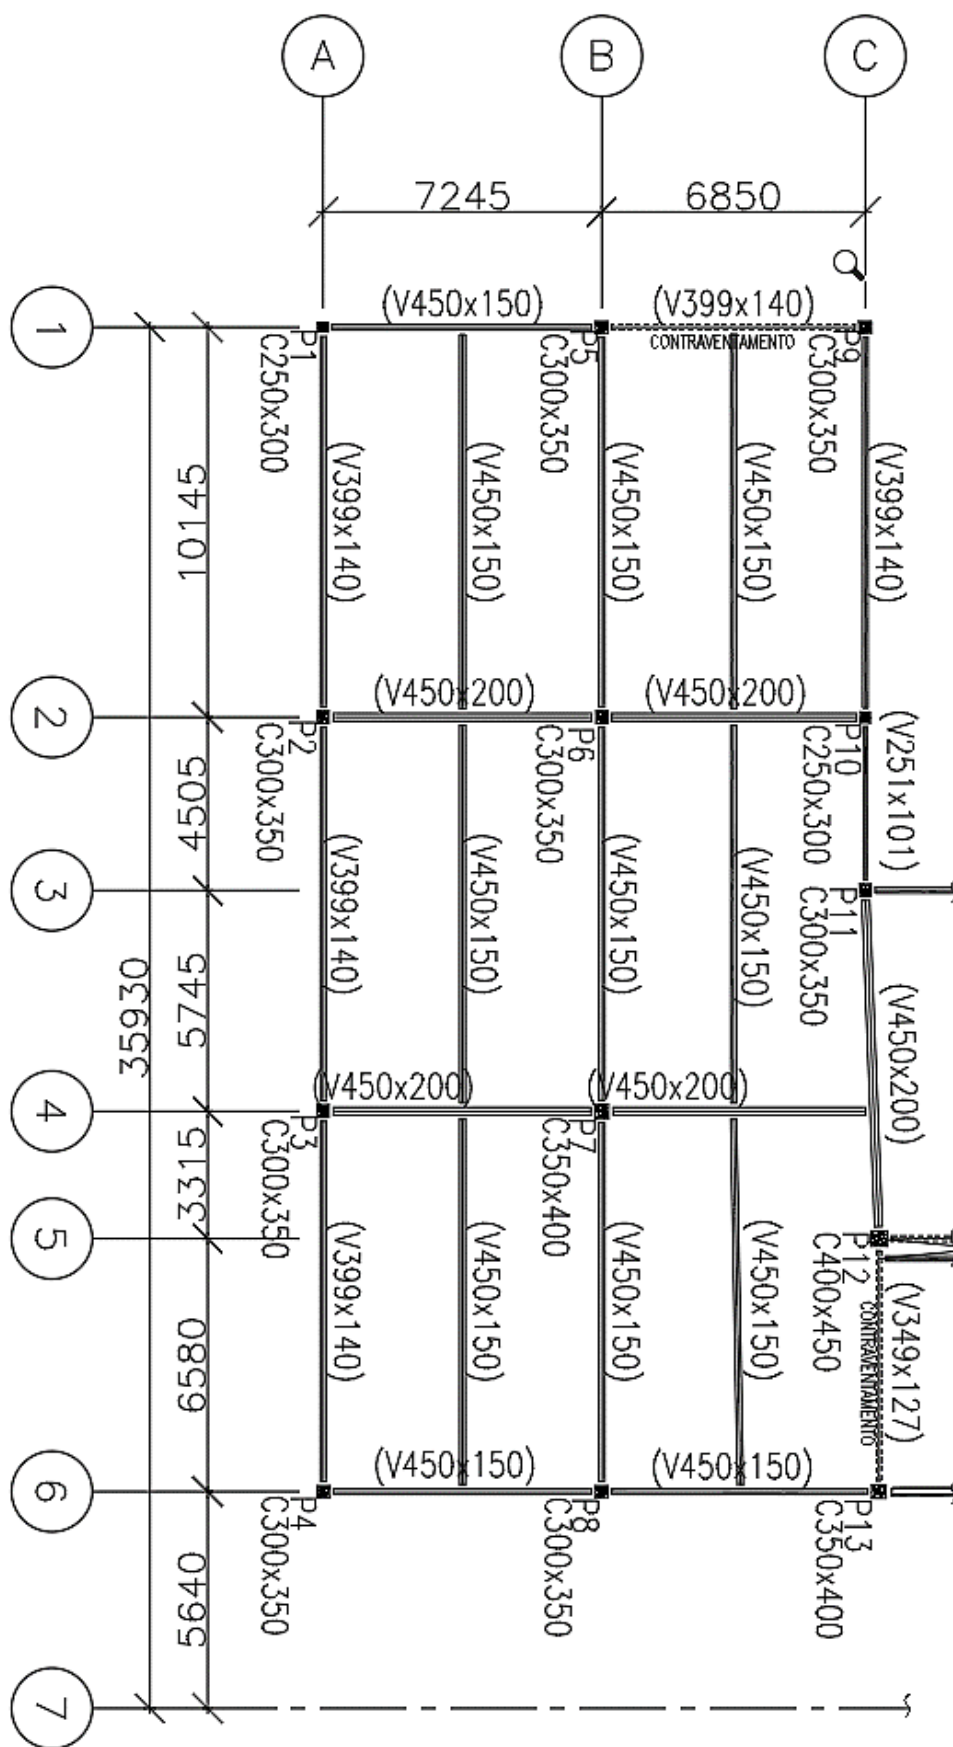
Dimensões e seções transversais dos perfis do Lado A (cotas em mm).
